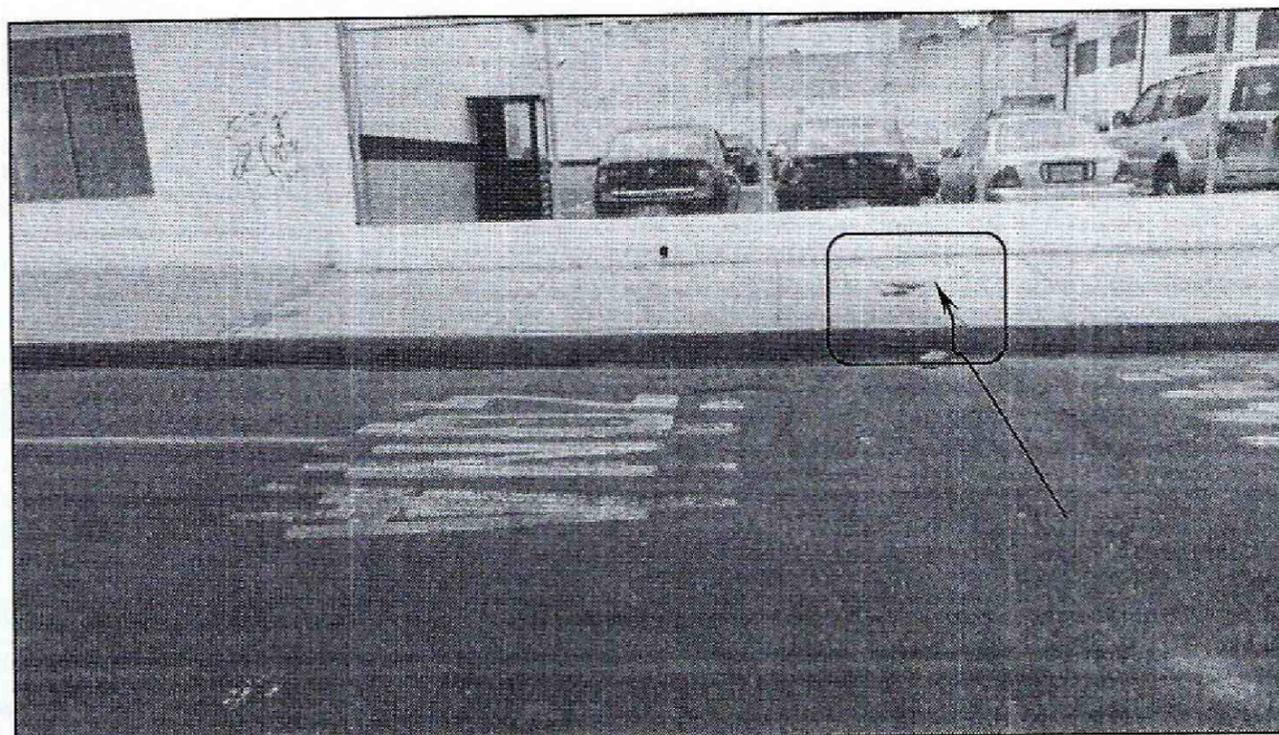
y 5. Vista de las fisuras en juntas de muros de la vivienda ubicada en el predio de la Calle 65 No. 15-30, en el Sector Catastral La Esperanza, de la Localidad de Barrios Unidos
